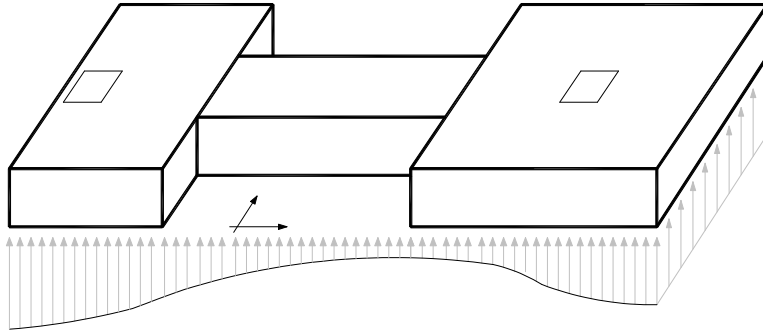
Zapata Excéntrica con Viga Riostra. Modelo Elástico Simplificado.
